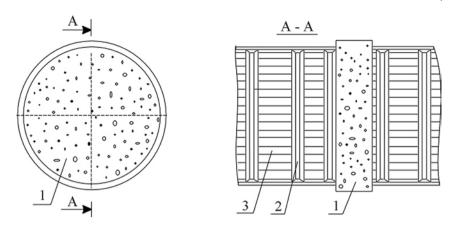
Схема бетонной шахтной перемычки в горной выработке круглого поперечного сечения: 1 – перемычка, 2 – металлическая крепь из спецпрофиля,
